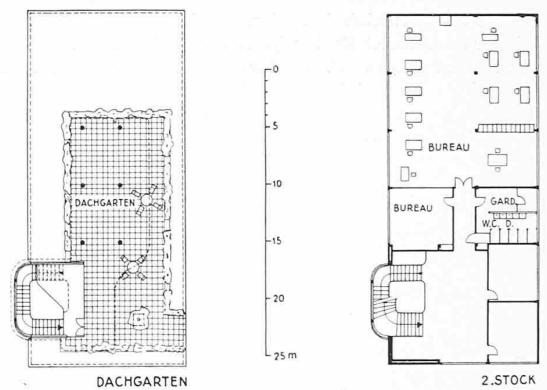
Grundrisse und Schnitte des Verwaltungs-Gebäudes. — Masstab 1:600
